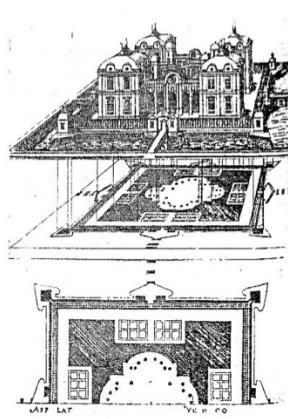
Androuet du Cerceau. Plano e elevação de um edifício, 1576.
